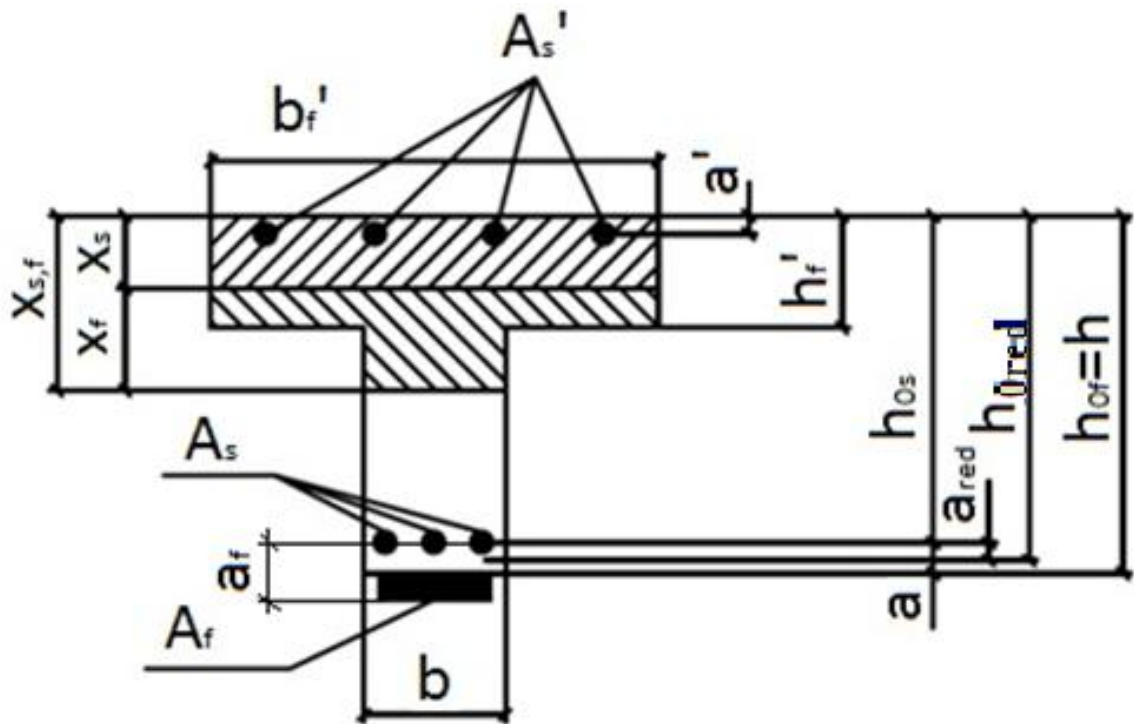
Расчетная схема для универсального метода расчета элемента таврового профиля по второму случаю ($x > h'_f$)
